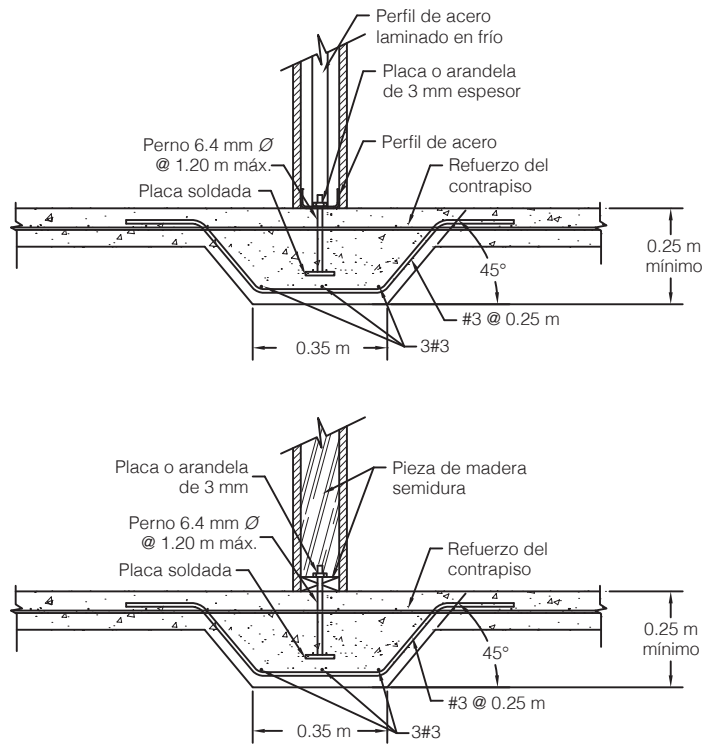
Fundación para planchas delgadas a doble forro.
